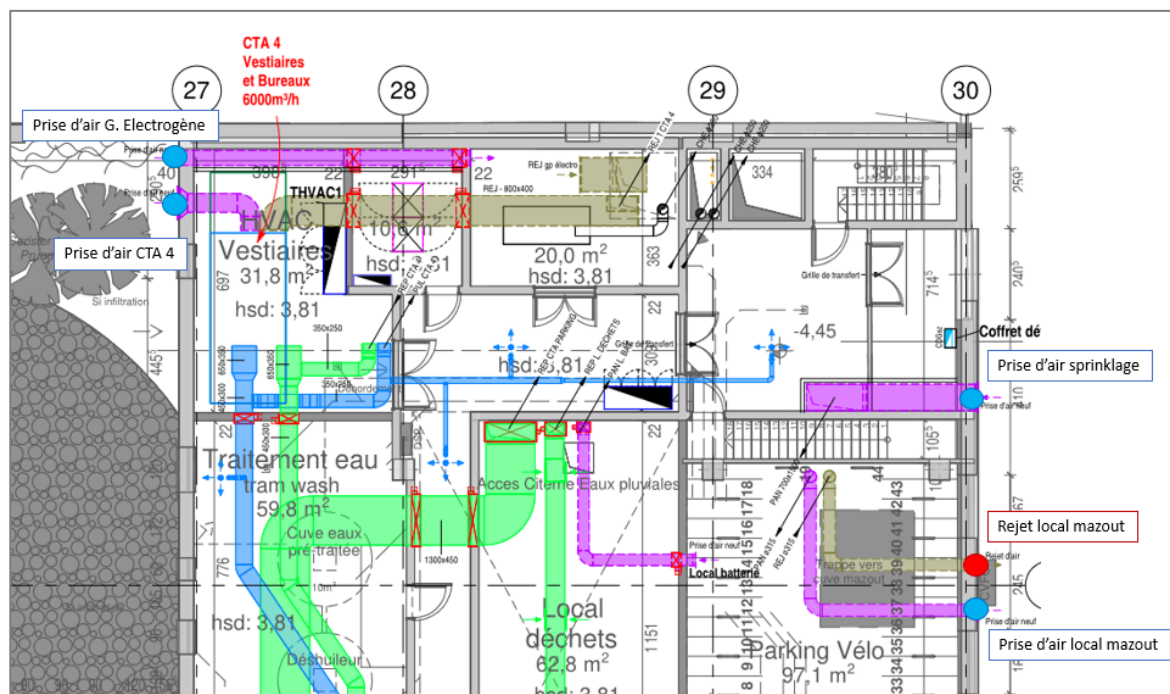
Prises et rejets d'air localisés au R-2 – Rez-de-chaussée Birmingham (source : Architecte)
